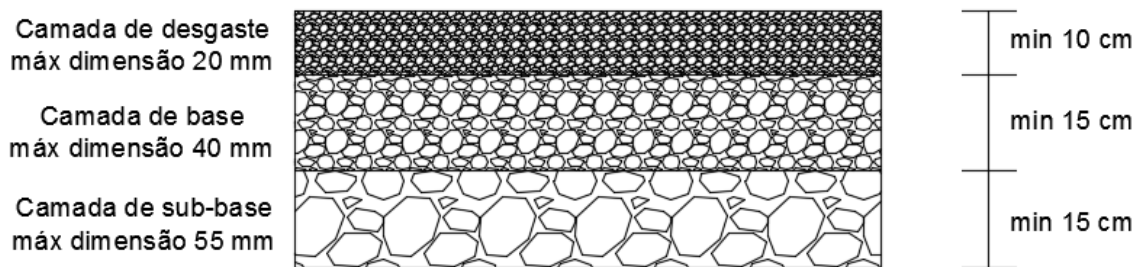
Esquema tipo de um pavimento de classificação U1.
